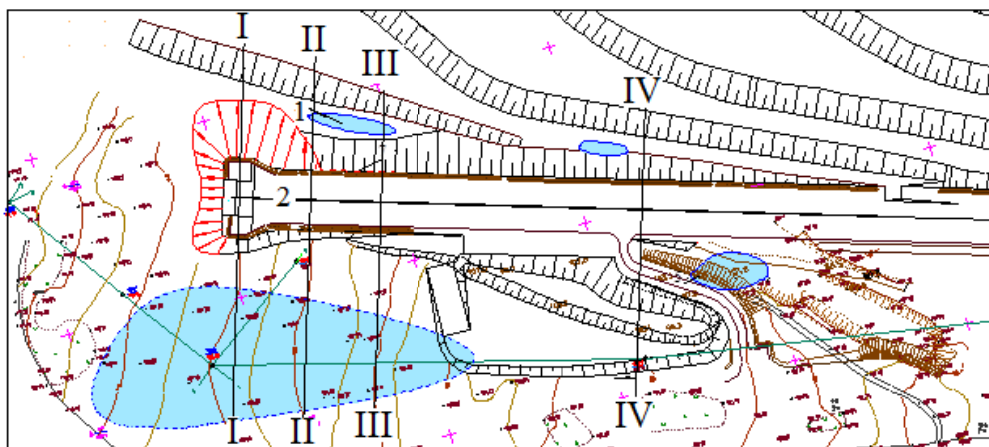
План строительства насыпи ЦПТ [1]: 1 – водоем под оползнем; 2 – верхняя площадка насыпи; I-I', II-II', III-III', IV-IV' – оползнеопасные профили насыпи
